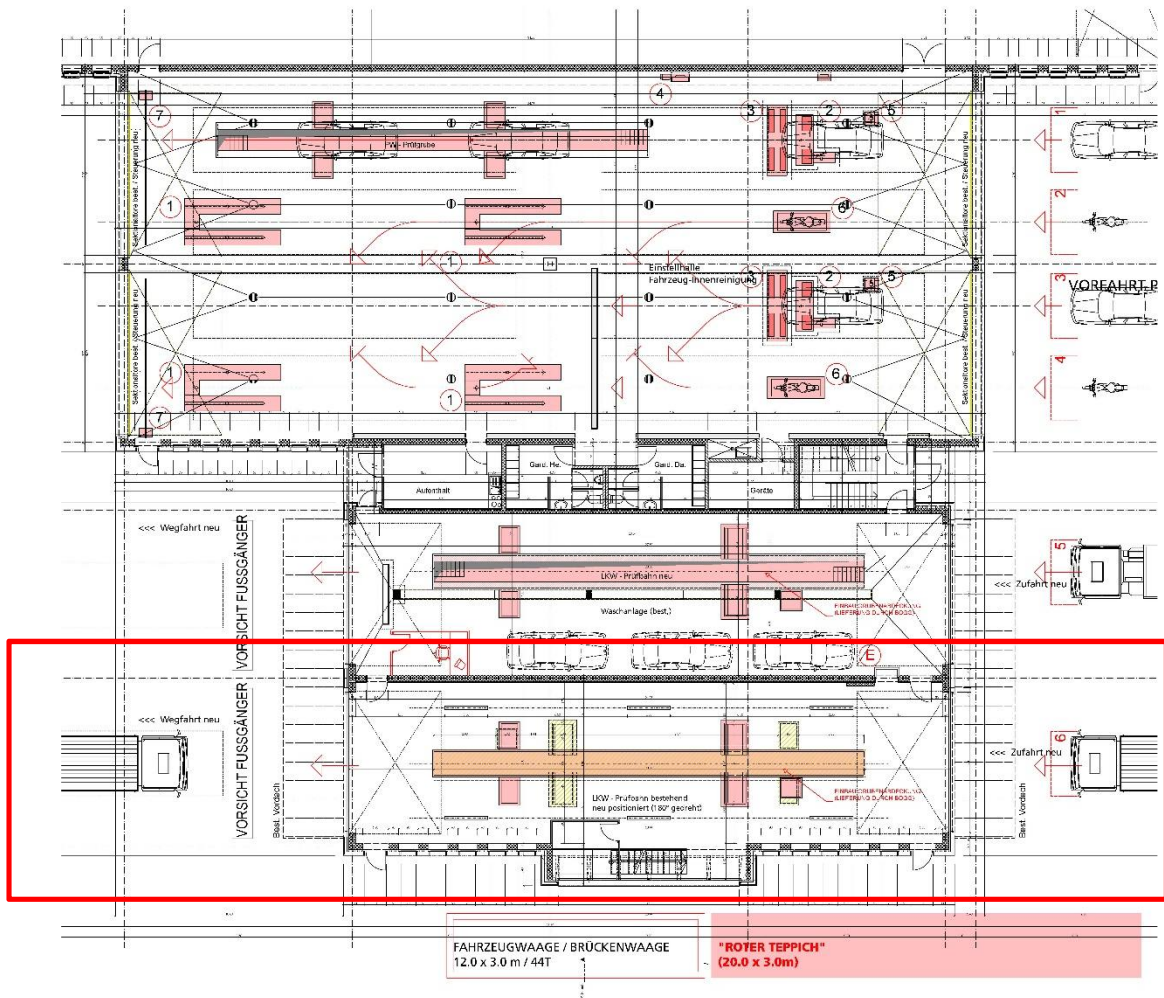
Grundrisslayout Prüfhalle 3, Erdgeschoss
